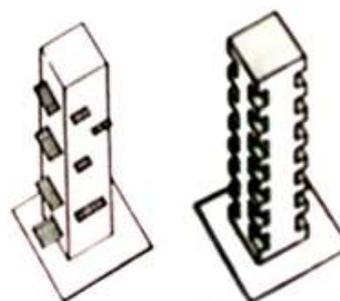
Corner shading adjustment*. (Yeang, 1994).
